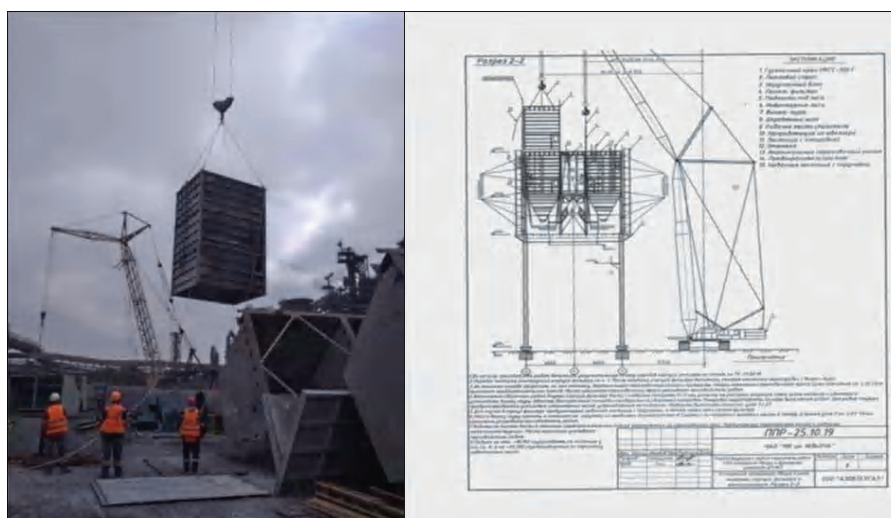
Подъем металлоконструкций монтажных блоков стен корпуса фильтра.
